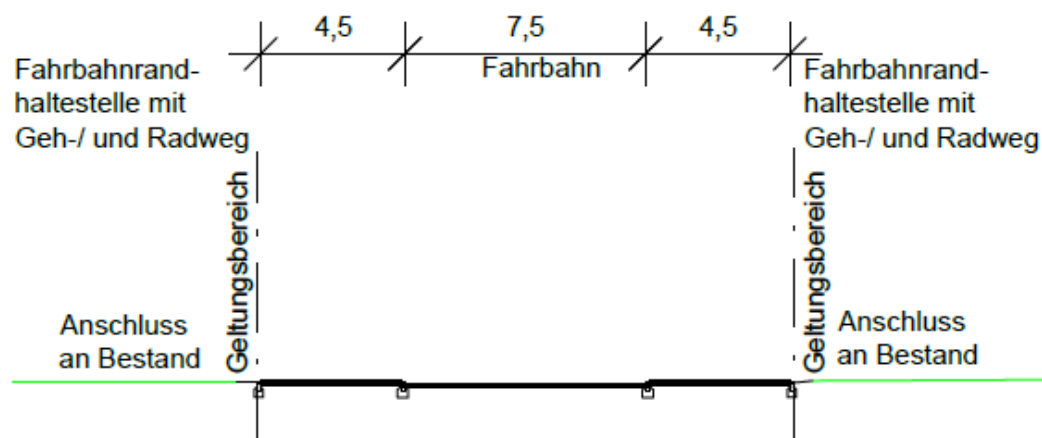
Querschnitt Kremser Straße C-C am Westrand des Bebauungsplangebiets, Ausschnitt aus Bebauungsplan Nr. 195 "Südlich der Kremser Straße", Stadt Regensburg
